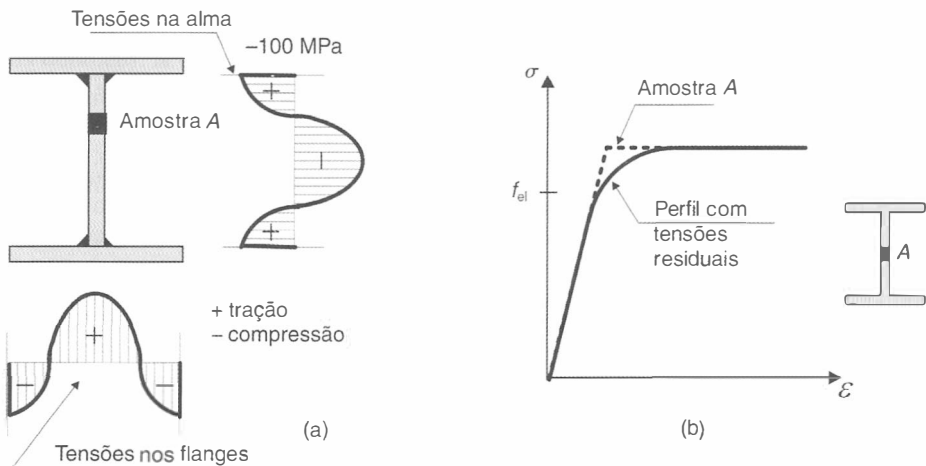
(a) Aspecto das tensões residuais em um perfil I soldado; (b) Diagrama σ , ϵ para perfis simples ou compostos (aço com patamar de escoamento).
